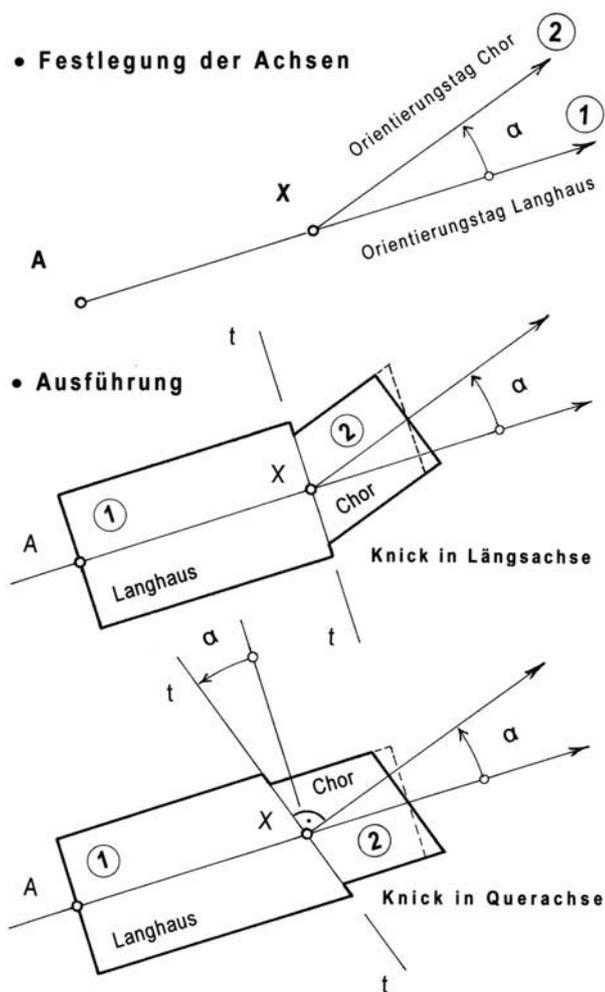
Orientierung und Absteckung von Kirchengrundrissen
